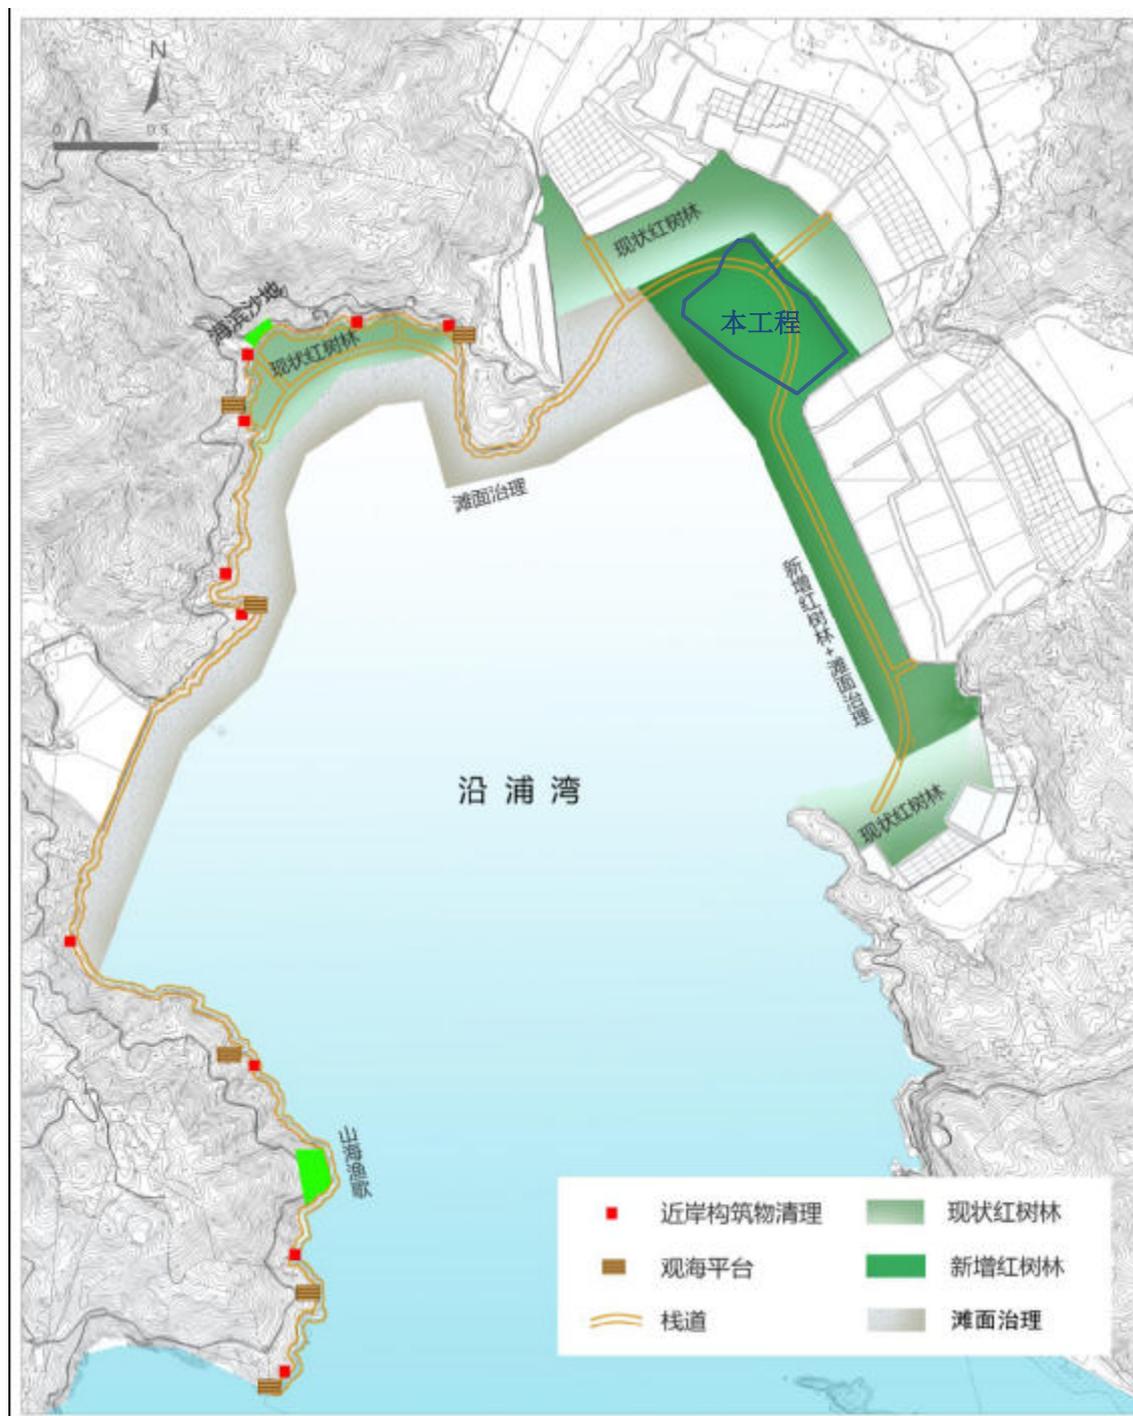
海湾红树林湿地公园工程平面布置示意图
